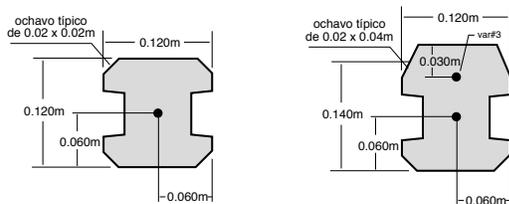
Detalle de secciones de columnas 12x12cm y 12x14cm
